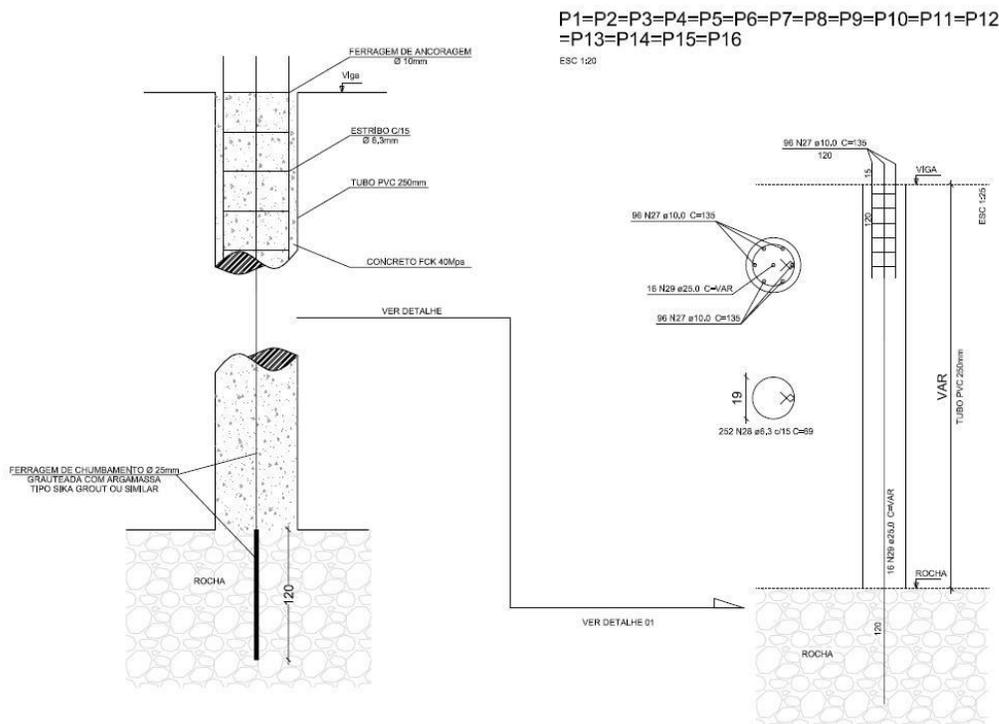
Detalhe dos pilares executados sobre enrocamento. Sem escala.
